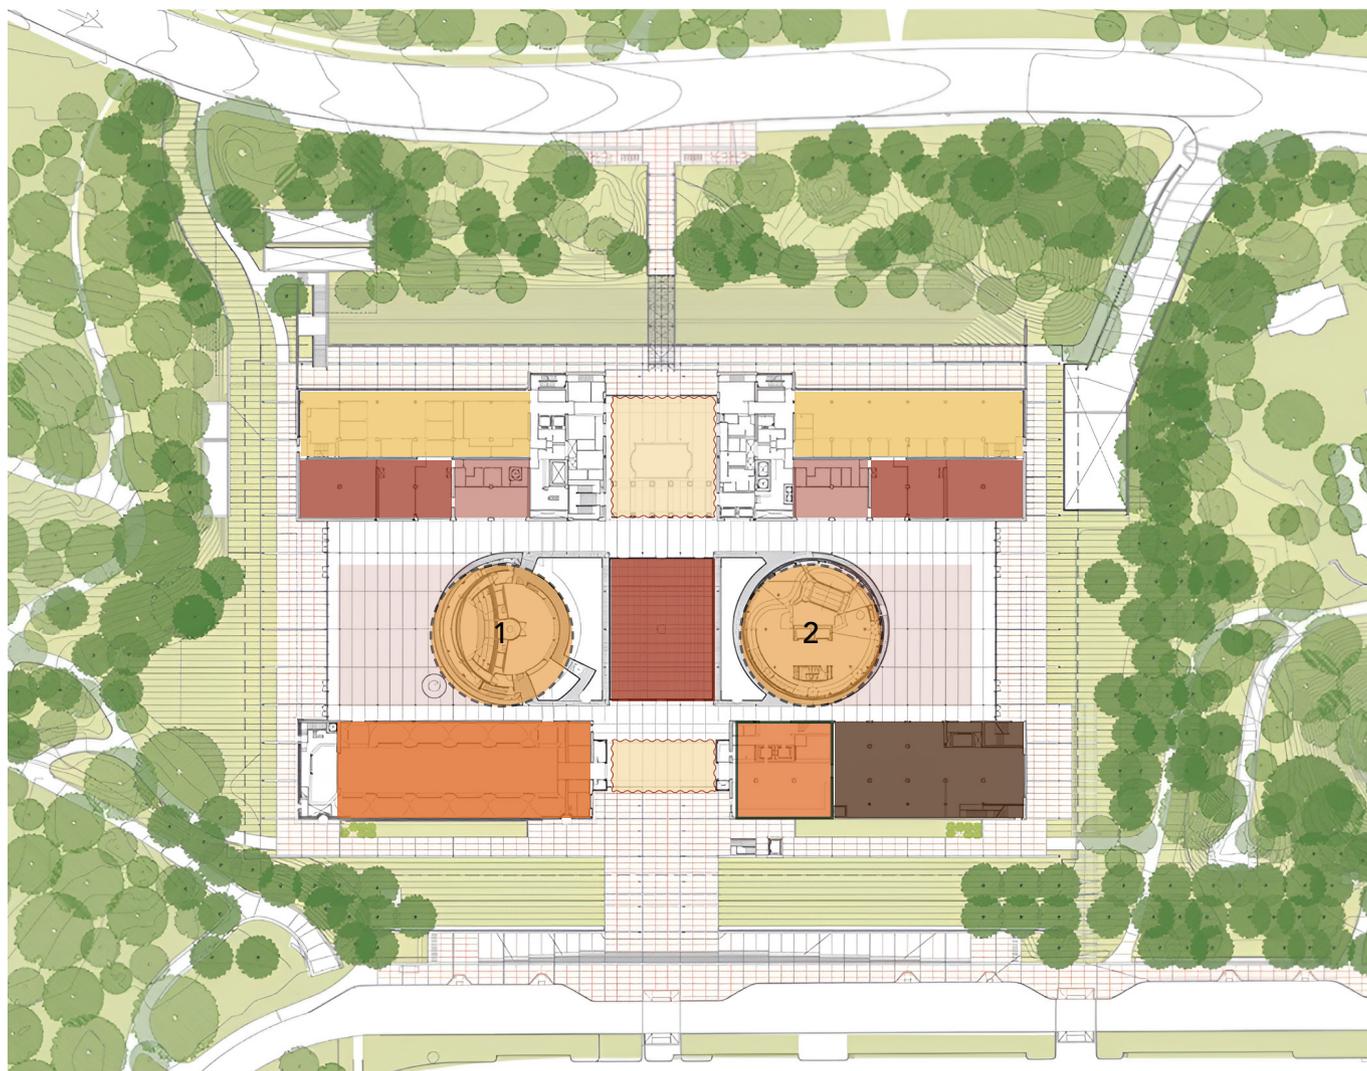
Distribución de áreas de la planta arquitectónica del museo
